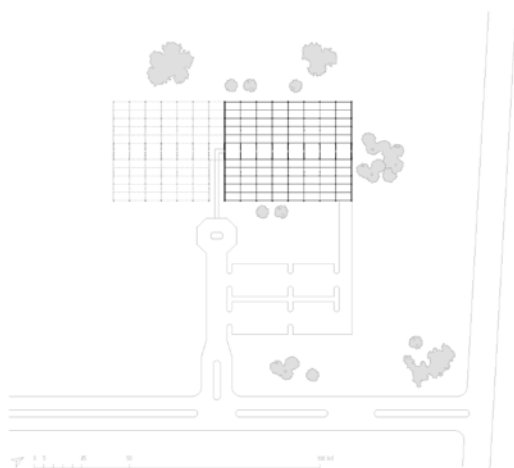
Plano de la planta de la cubierta de la fábrica PA Technology. Fuente: Elaboración propia.
